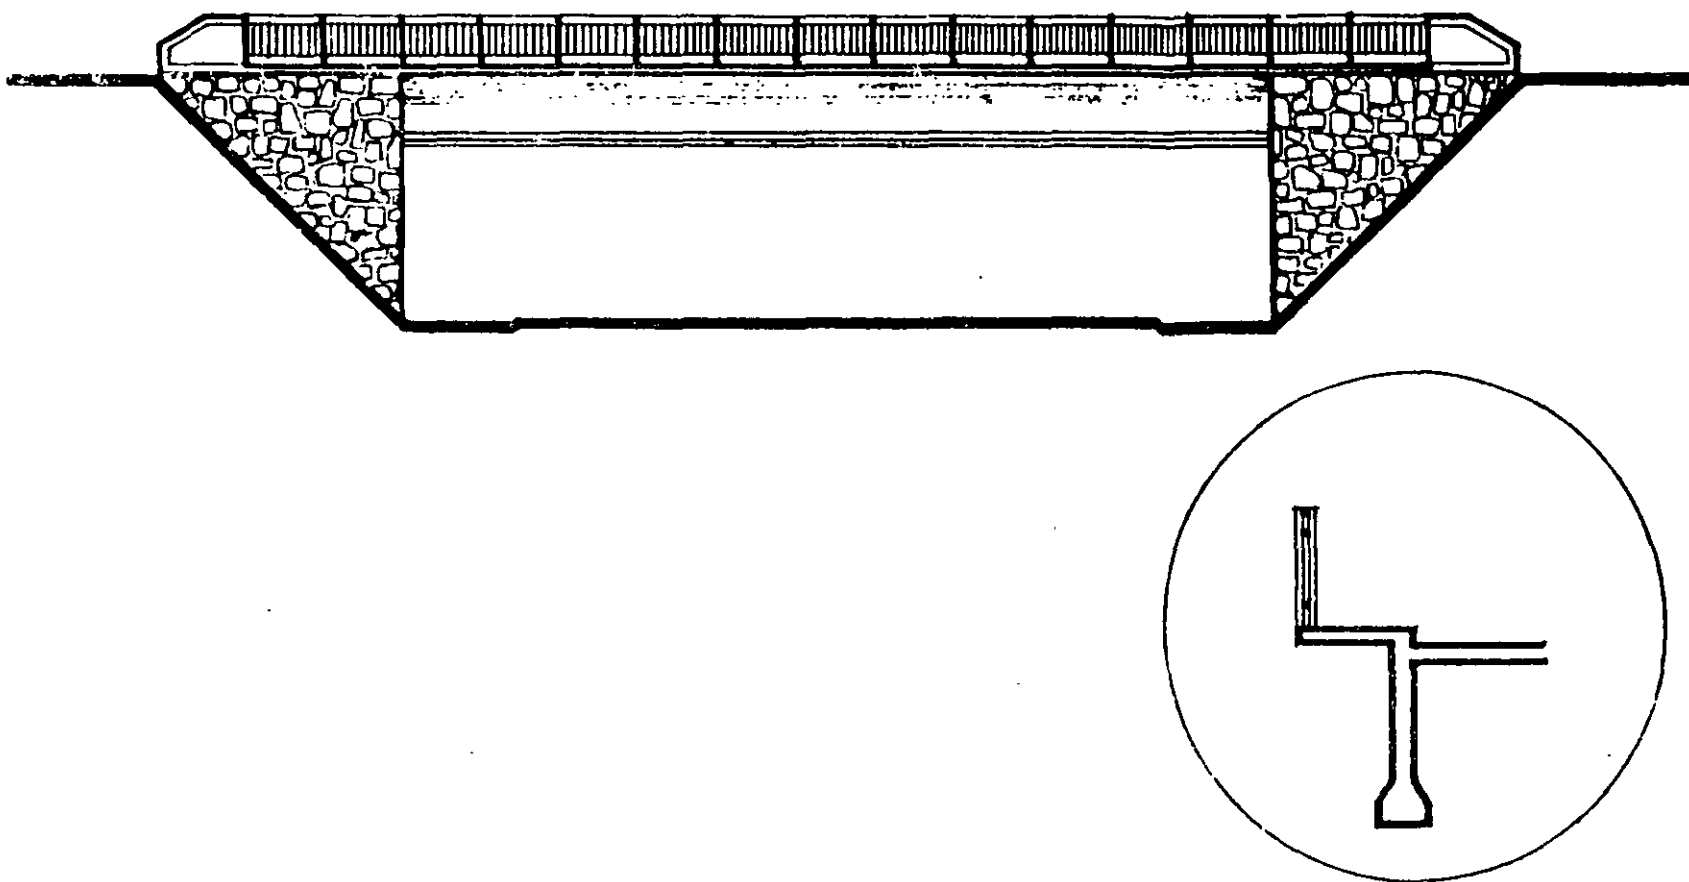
PARAPETO METALICO CON REMATES DE CONCRETO
